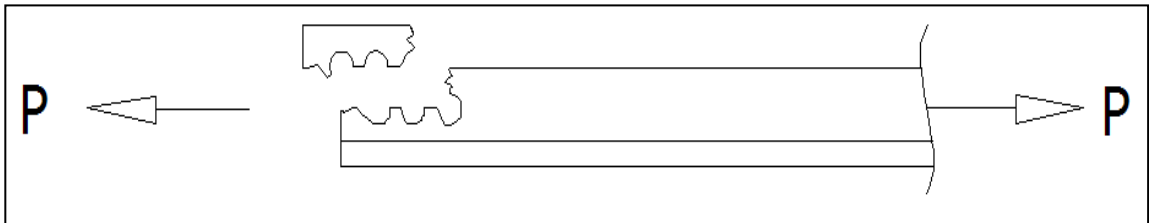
Falla por bloque de cortante (Ruptura por cortante y tensión combinados).
